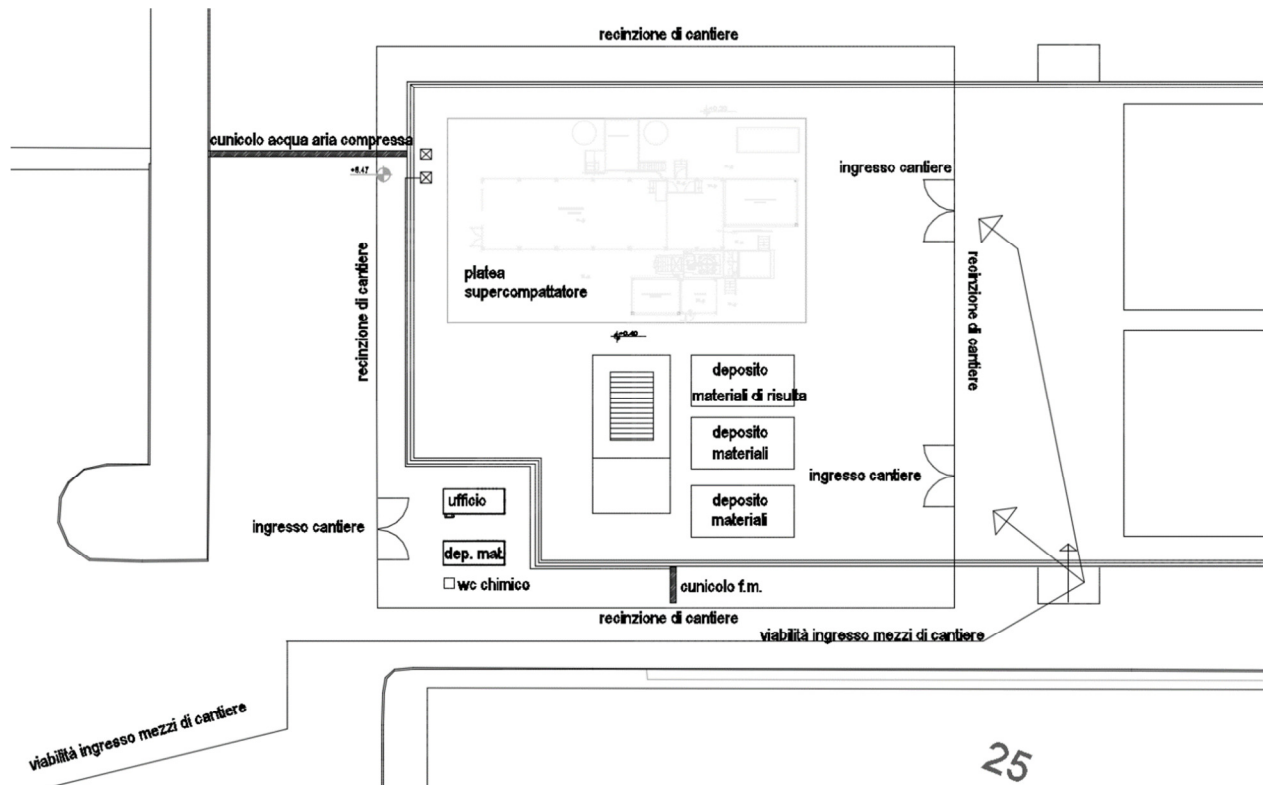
Lay out di cantiere per le opere di predisposizione dell'area destinata all'installazione del sistema trasportabile
